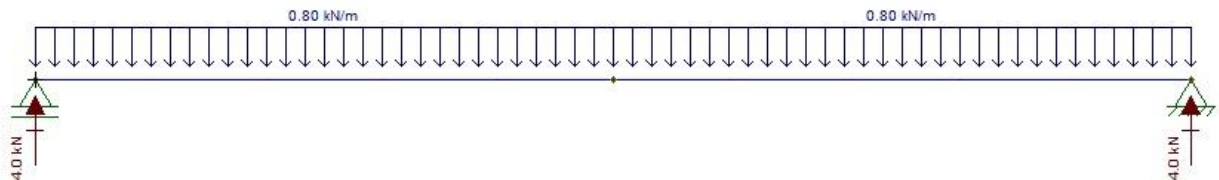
Esquema estrutural de viga biapoiada, representando as reações da cobertura de madeira.
